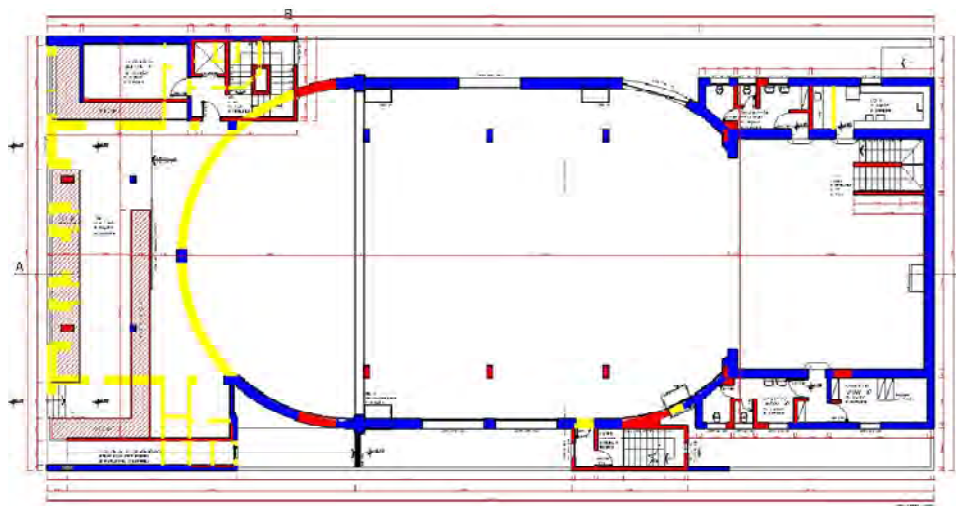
Planta Baixa Reforma Pavimento Térreo Cine Teatro Imperial
